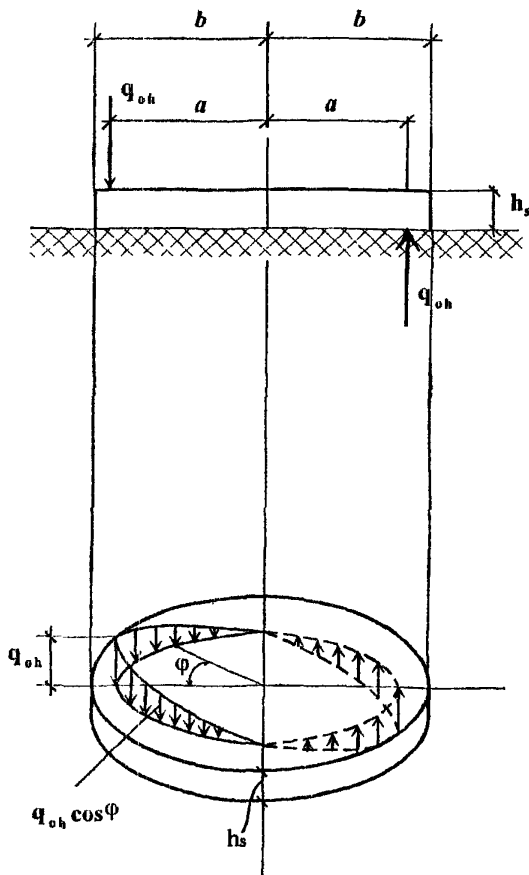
Схема к расчету фундаментной плиты на нагрузки от гидродинамического давления
